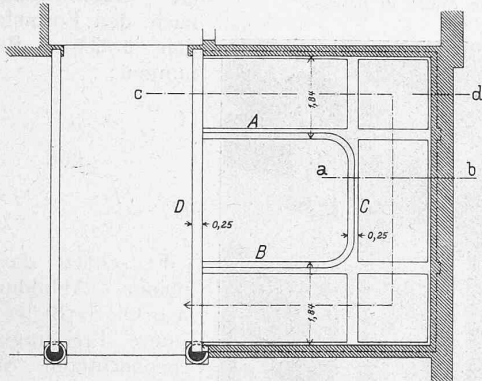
Grundriss vom Erdgeschoss. — Masstab 1 : 500.
